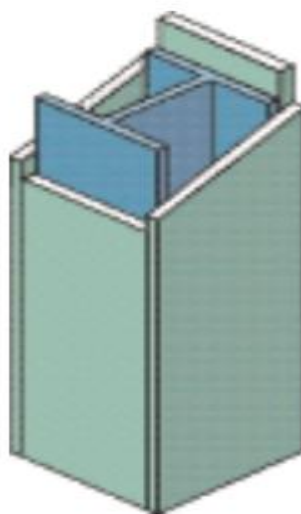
exemple d'une protection à l'aide de produits en plaques [9]
